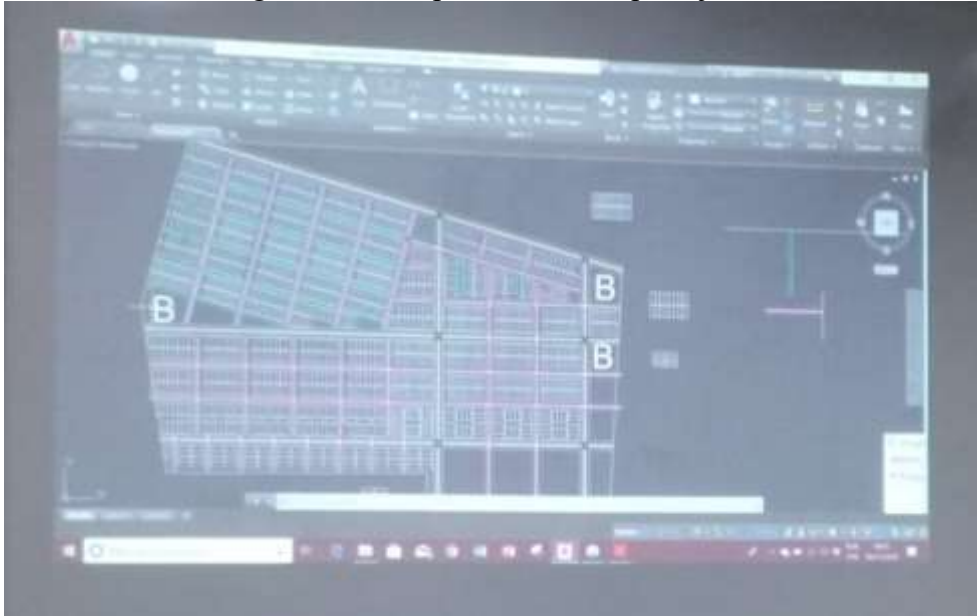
Seleção de logradouro para construção de bairro planejado
